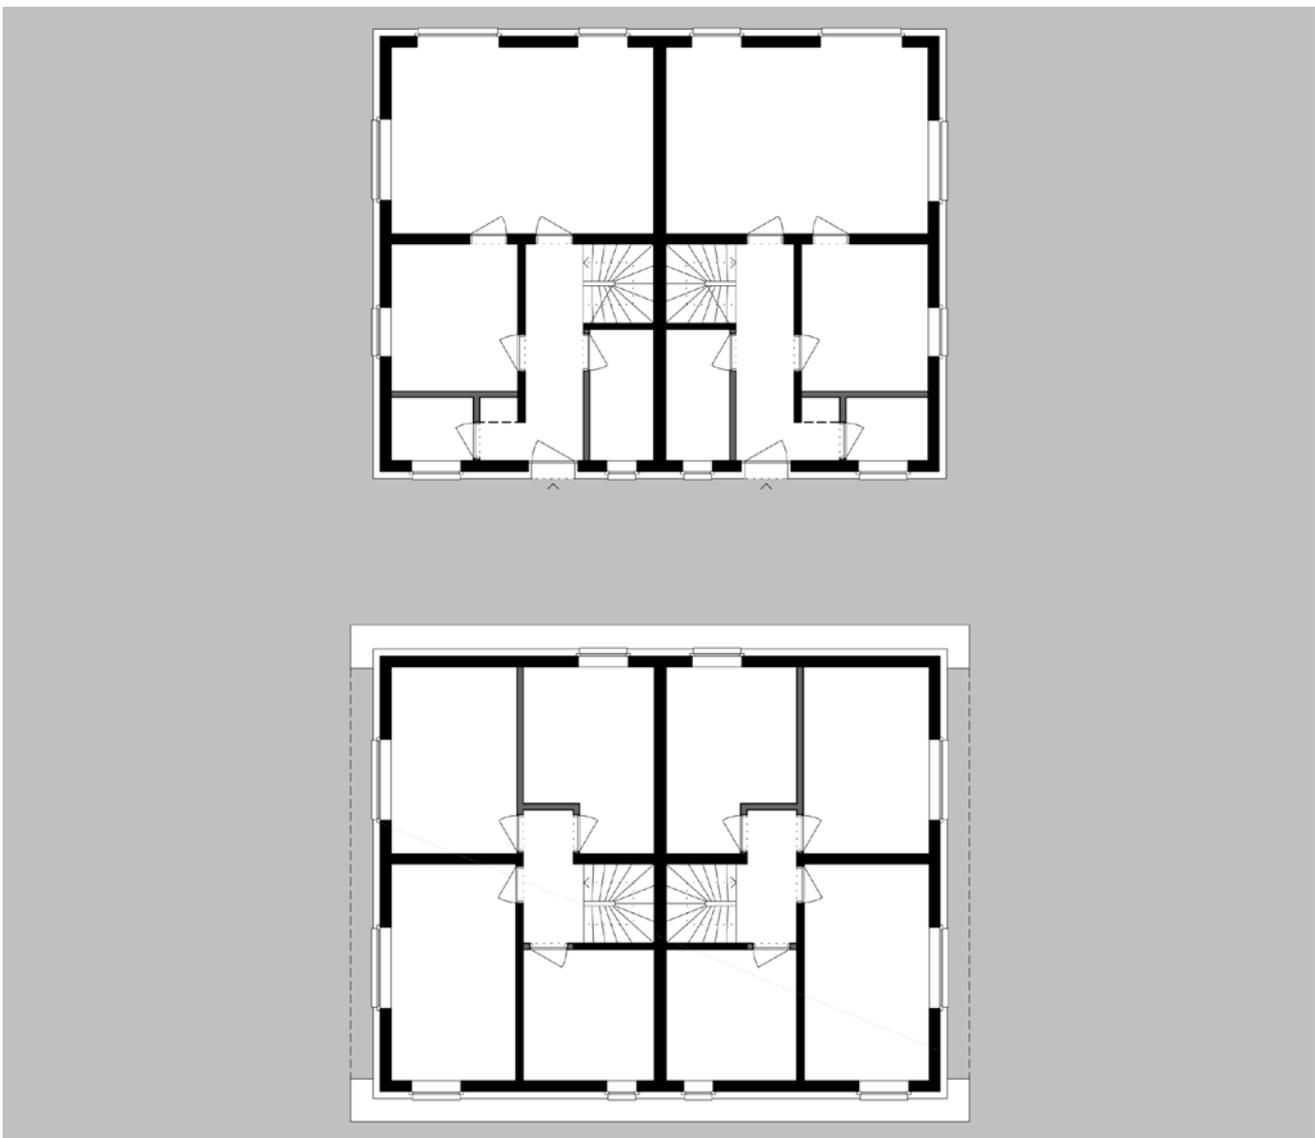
Referenzgebäude als Doppelhaus (DH) mit zwei Stockwerken, dargestellt in den Grundrissen für Erdgeschoss und Obergeschoss
